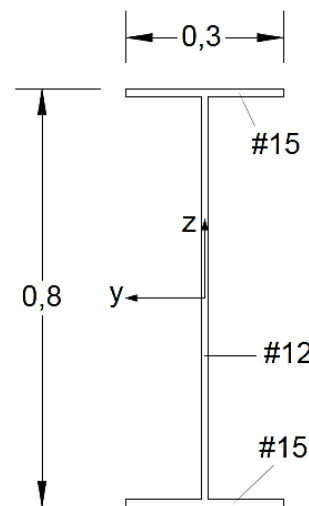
Sección transversal viga de piso en centro-luz de la misma. Elaboración propia con AutoCAD
